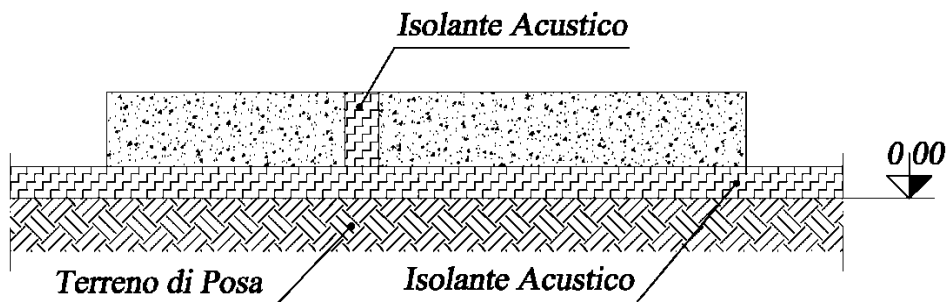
Sezione A-A della lastra di calcestruzzo (Monteforte, 1998).
